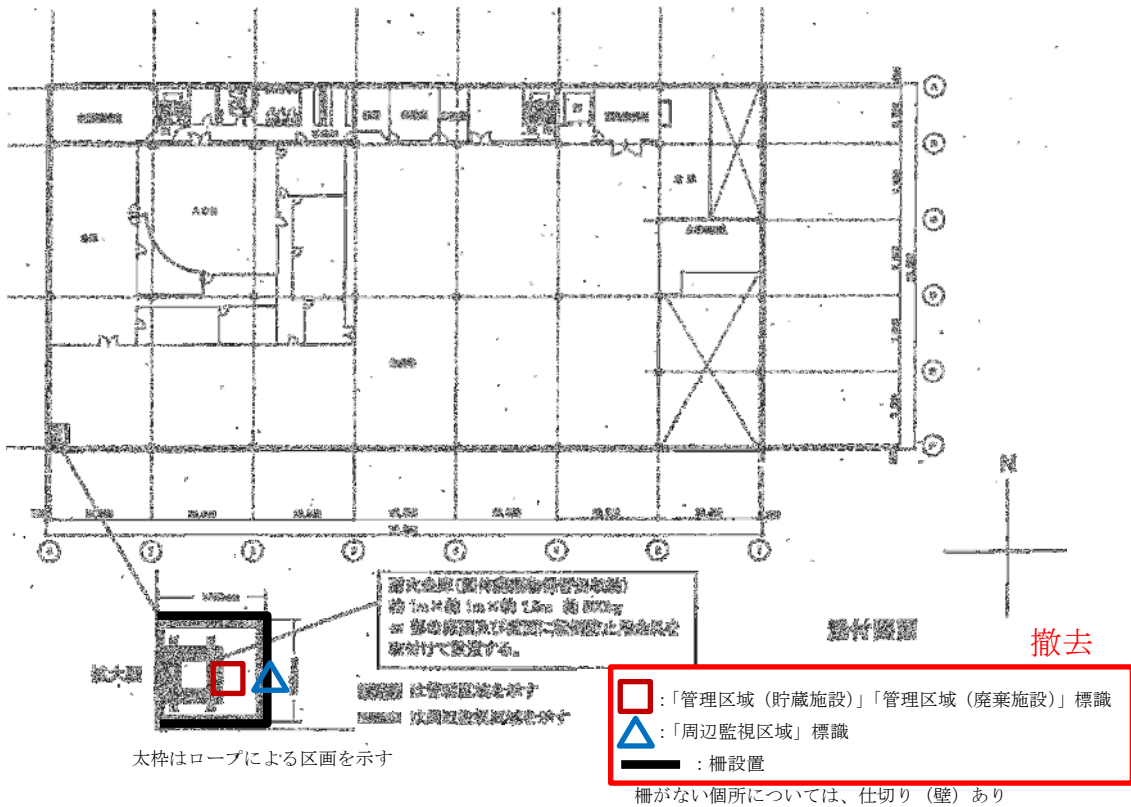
核燃料物質貯蔵施設、固体廃棄施設 614工場 3F 平面図
